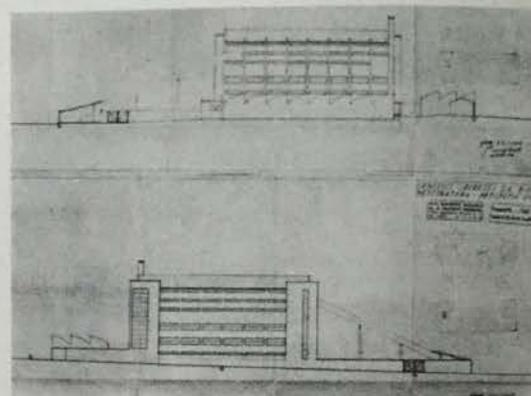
Ex Lanificio Rivetti: prospetto est e prospetto ovest.
